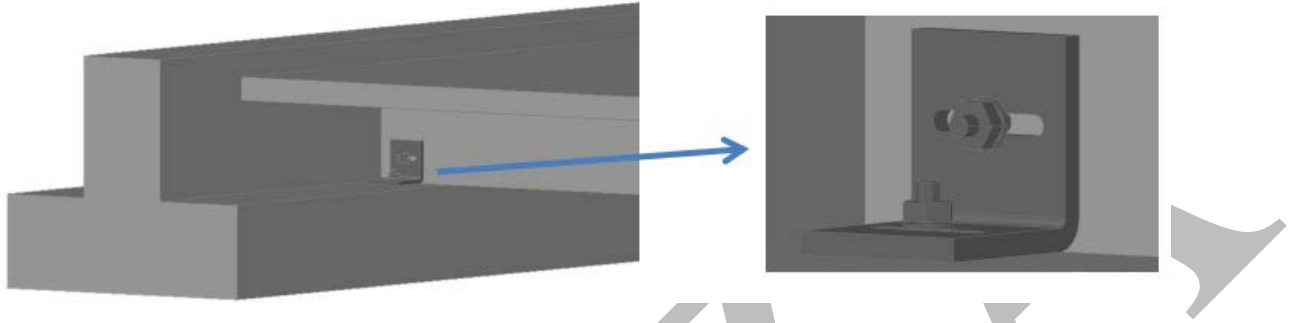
Rinforzo connessione tegolo-trave: aggiunta di meccanismi di dissipazione con squadrette deformabili
